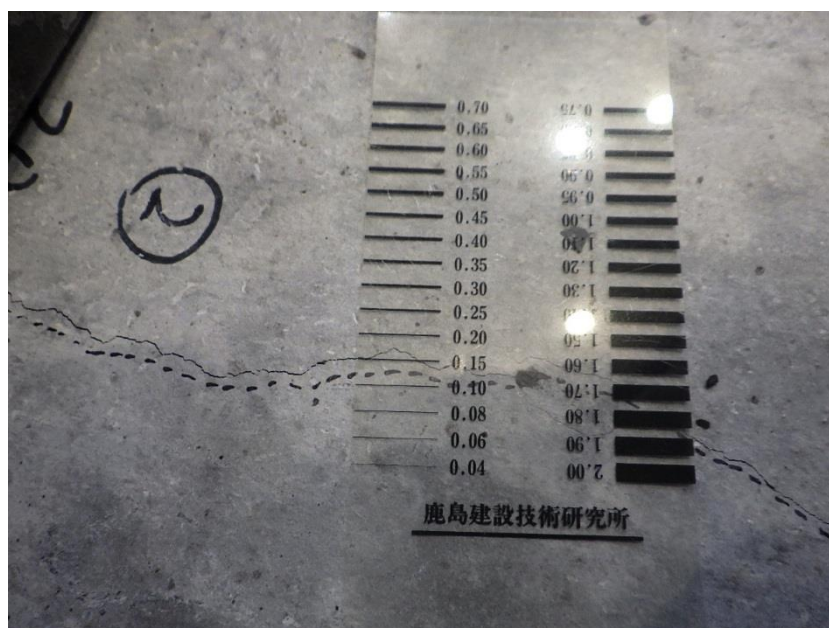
鉄筋コンクリート試験体ひび割れ発生状況 (①拡張後 2/2)
